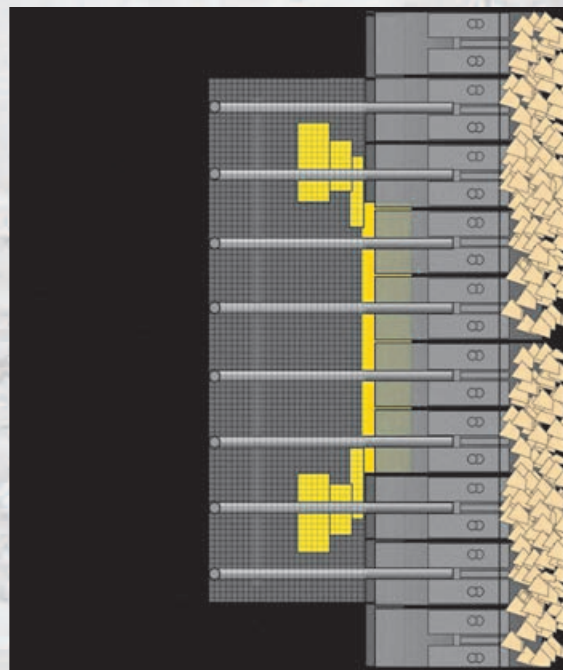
Schematische Darstellung eines Walzenstalls (Grundriss).
